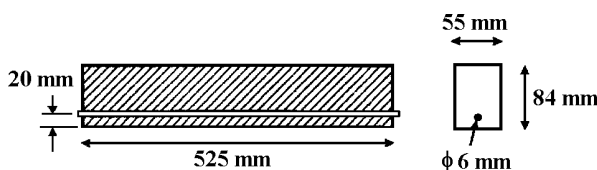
Vigas Ensaçadas por LAU e ZHOU (2001a)
